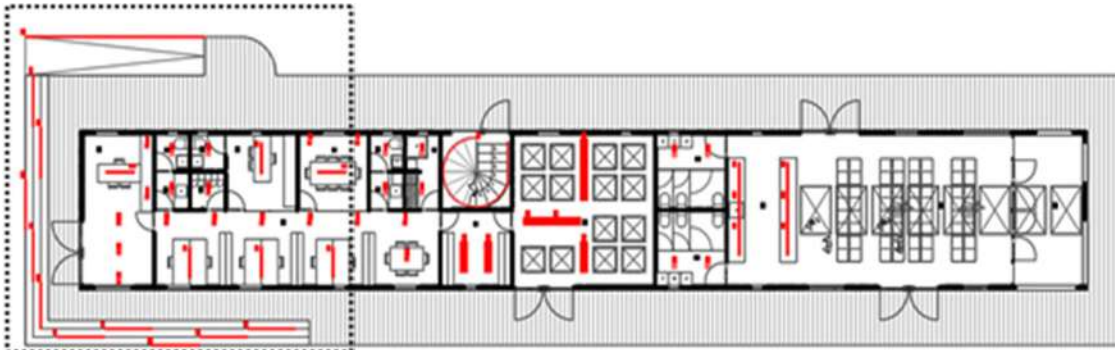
LAYOUT DE ILUMINACIÓN EXTERIOR PROYECTO DETONANTE
